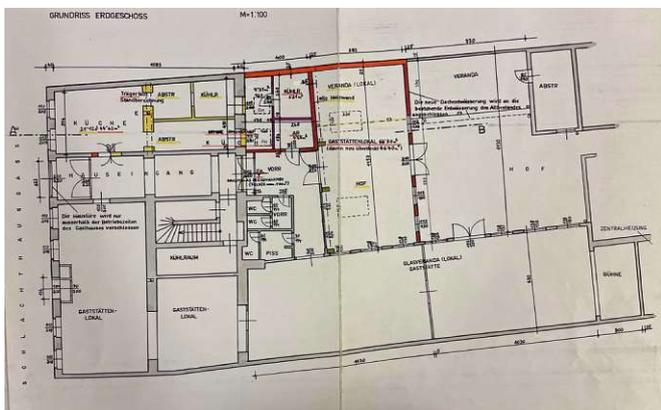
Grundriss Zubau Gasthaus, 1980
